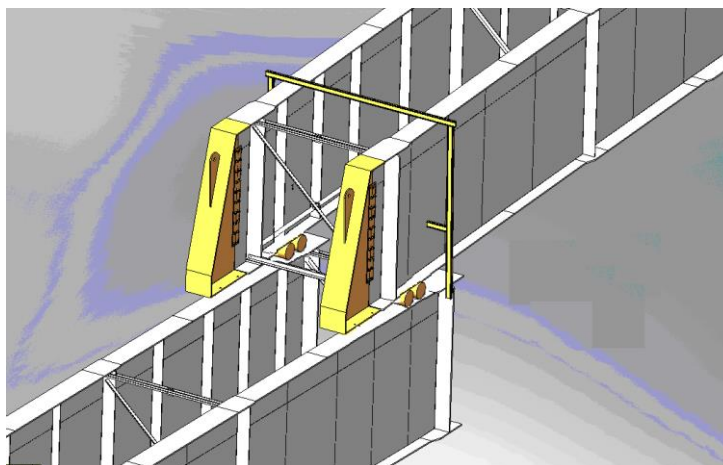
Extensiones de vigas y rodillos acoplados al siguiente tramo del par de vigas metálicas
